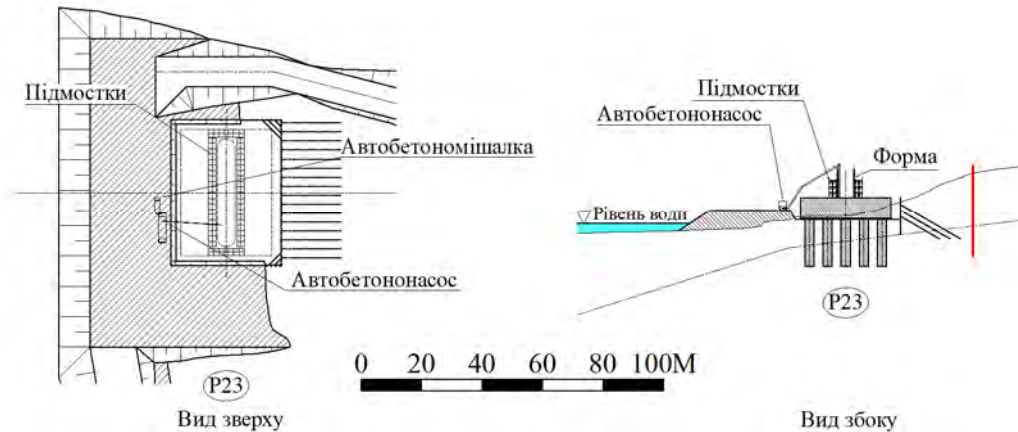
Довідкове креслення для зведення опор (укладання бетону)
